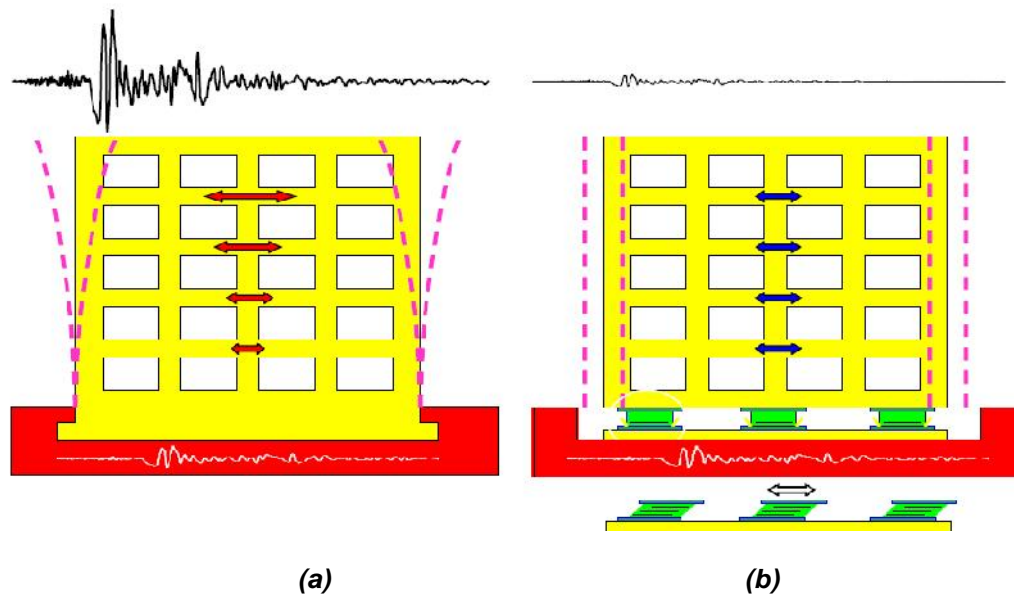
Esquema de dos tipos de edificios (a) Estructura sin aislamiento basal; (b) estructura con aislamiento basal.
